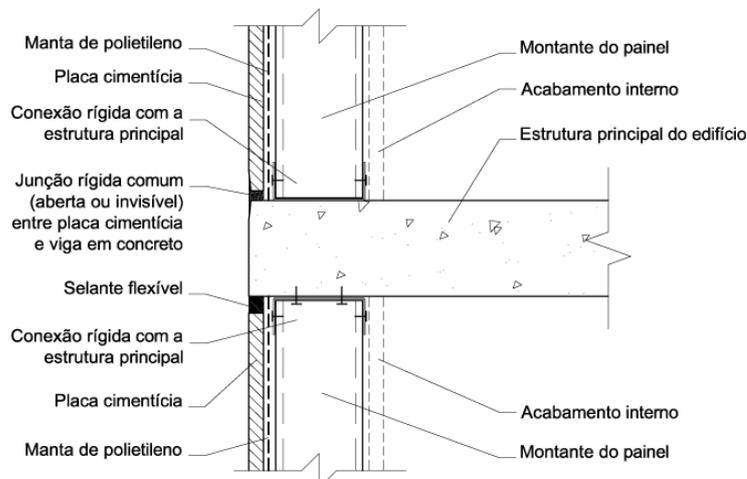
Painel embutido rígido com acabamento em placa cimentícia e estrutura principal aparente
